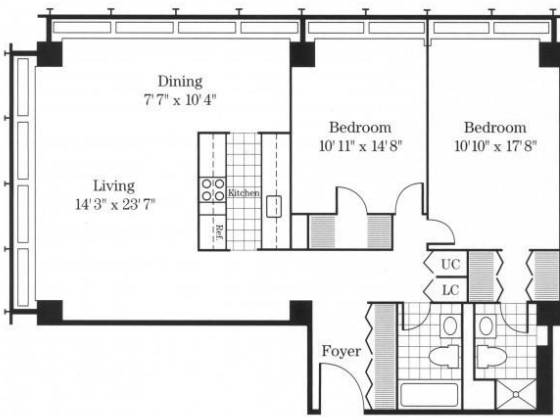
Planta de piso tipo, Laffayette Towers, , Detroit, Estados Unidos da América, 1956
